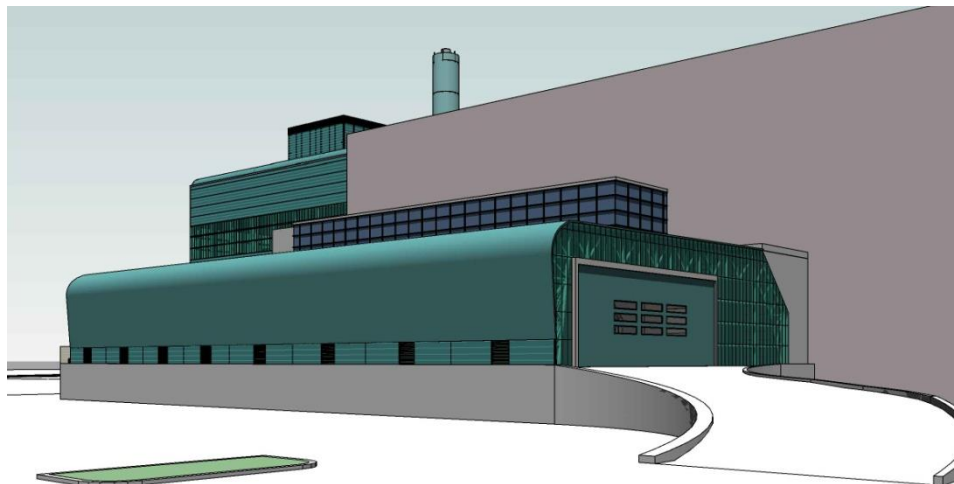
Vista dell'area di ingresso con l'Edificio Avanfossa in primo piano – stato di progetto
